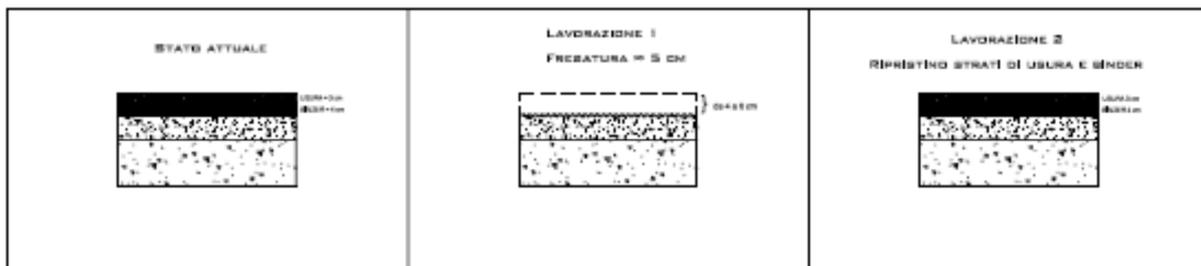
Ipotesi di rifacimento degli strati superiori della pavimentazione
